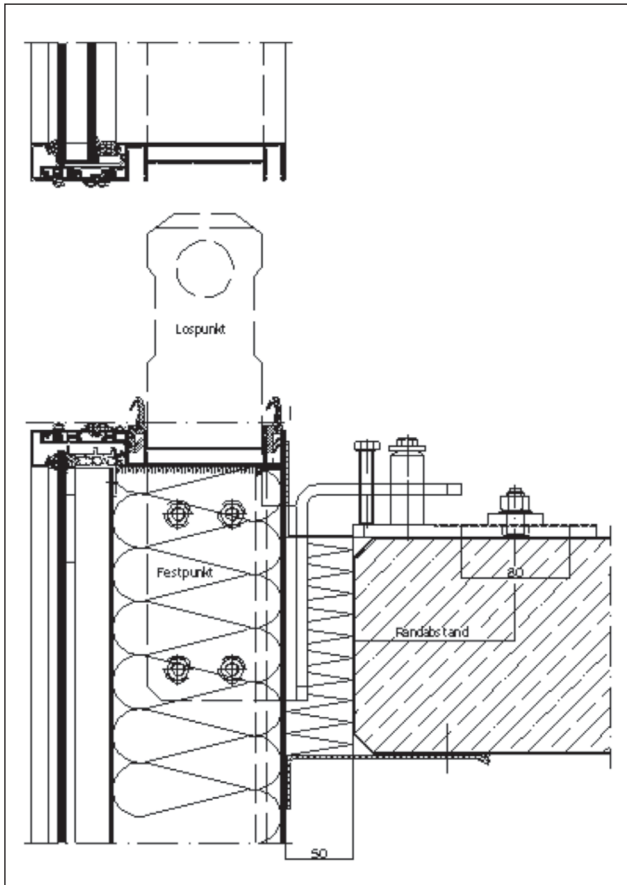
Fassadenkopplung vor dem Zusammenfügen – Vertikalschnitt
